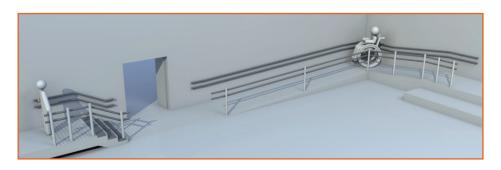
Planta de una rampa en esquina y detalle de encuentro con escalera y puerta de acceso a otra dependencia.
